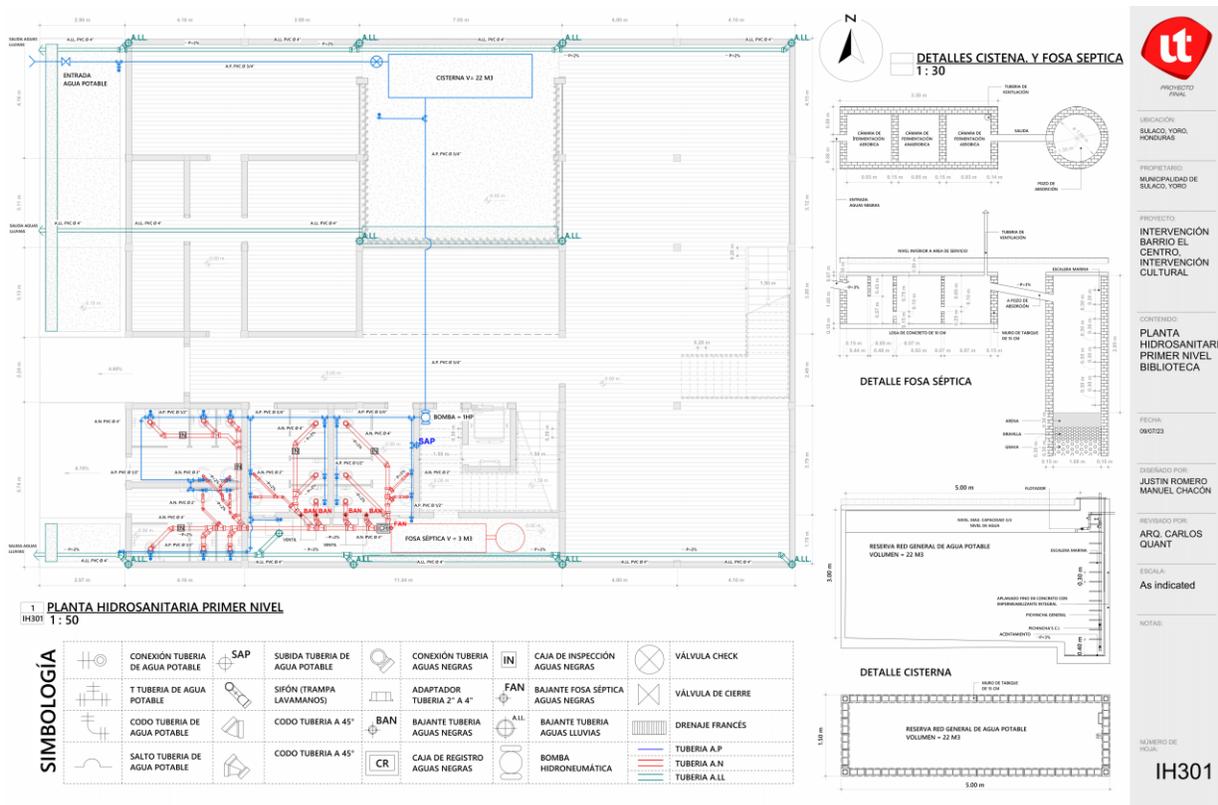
Planta Hidrosanitaria Primer Nivel | Fuente: elaboración Propia
